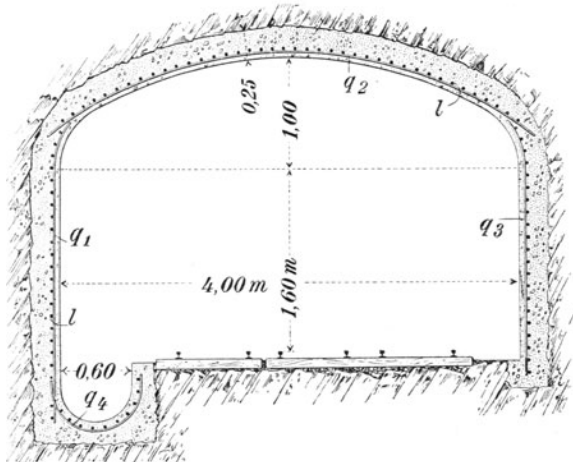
Eisenbetonausbau in einem Hauptquerschlag.
